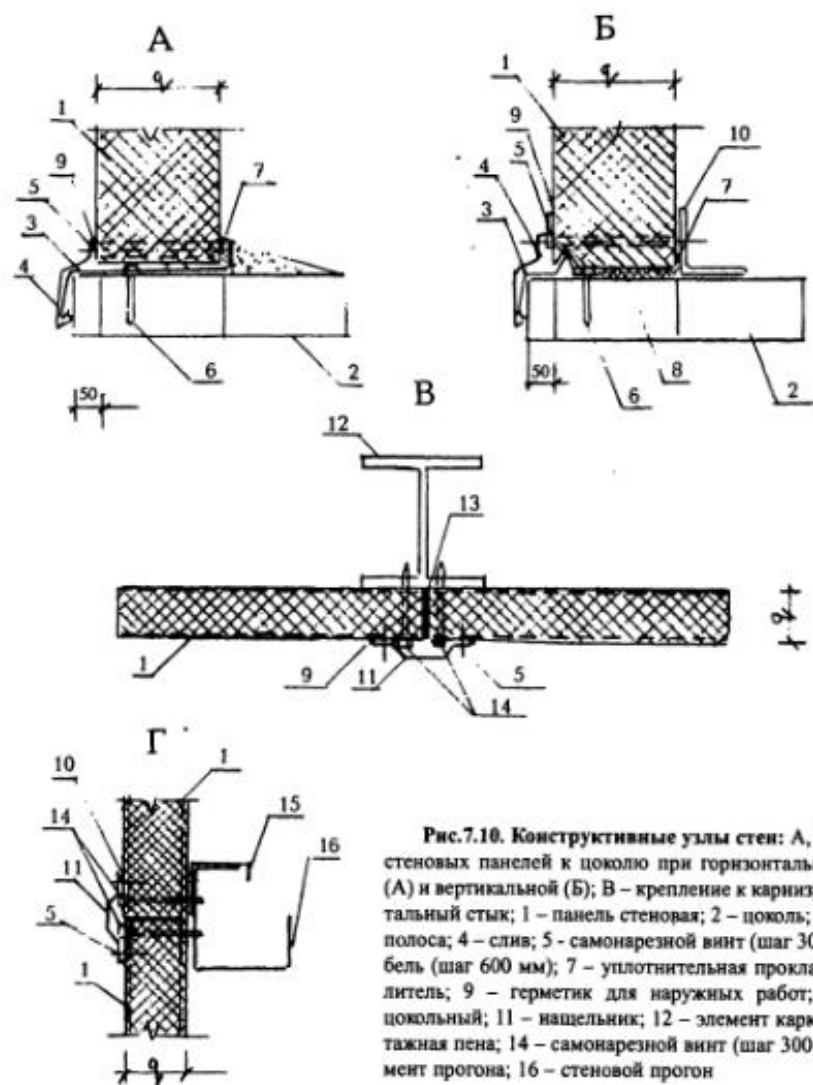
Конструктивные узлы стен: А, Б – крепление стеновых панелей к цоколю при горизонтальной раскладке (А) и вертикальной (Б); В – крепление к карнизу; Г – горизонтальный стык; 1 – панель стеновая; 2 – цоколь; 3 – крепежная полоса; 4 – слив; 5 – самонарезной винт (шаг 300 мм); 6 – дюбель (шаг 600 мм); 7 – уплотнительная прокладка; 8 – утеплитель; 9 – герметик для наружных работ; 10 – уголок цокольный; 11 – нащельник; 12 – элемент каркаса; 13 – монтажная пена; 14 – самонарезной винт (шаг 300 мм); 15 – элемент прогона; 16 – стеновой прогон
